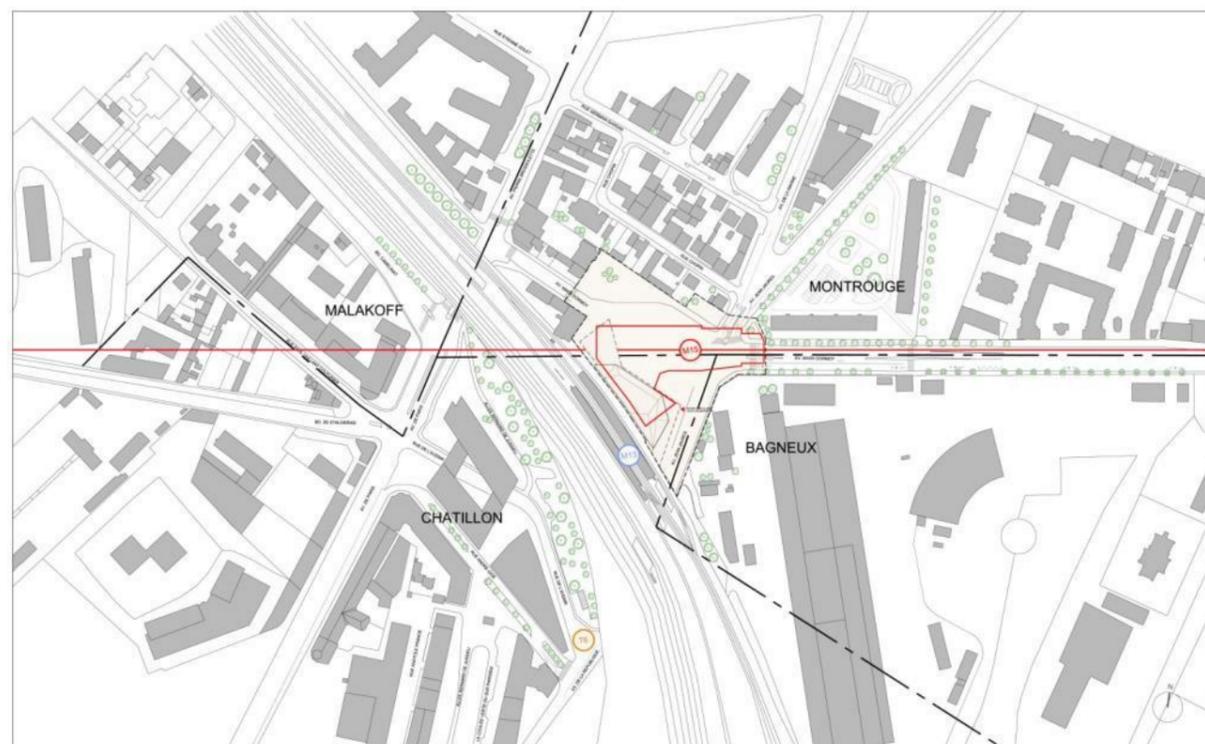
Gare de Châtillon Montrouge – plan de situation – échelle du quartier
